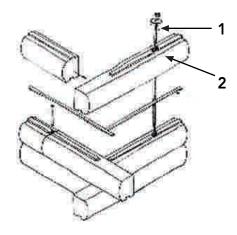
B. Cada tronco se va colocando uno sobre otro, amarrados en su interior con fierros verticales de diámetro de 8 mm (1) y sellando longitudinalmente el encuentro entre estos con espuma de poliuretano (2), como protección a la infiltración de aire y lluvia del exterior y salida de calor del interior.
